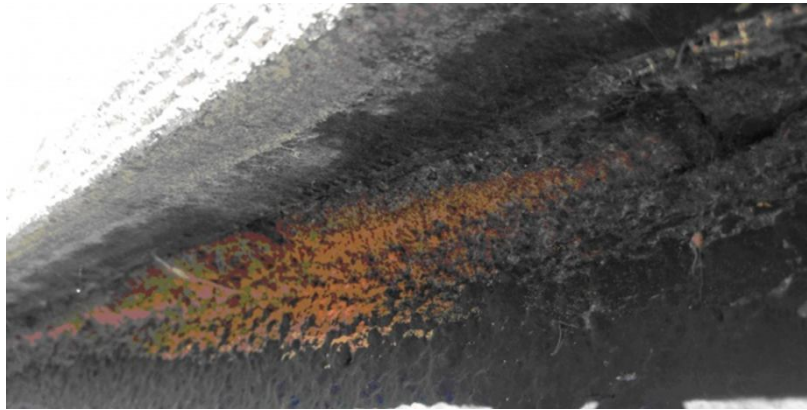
Разрушение шва между стеновыми панелями под системой утепления фасада здания
